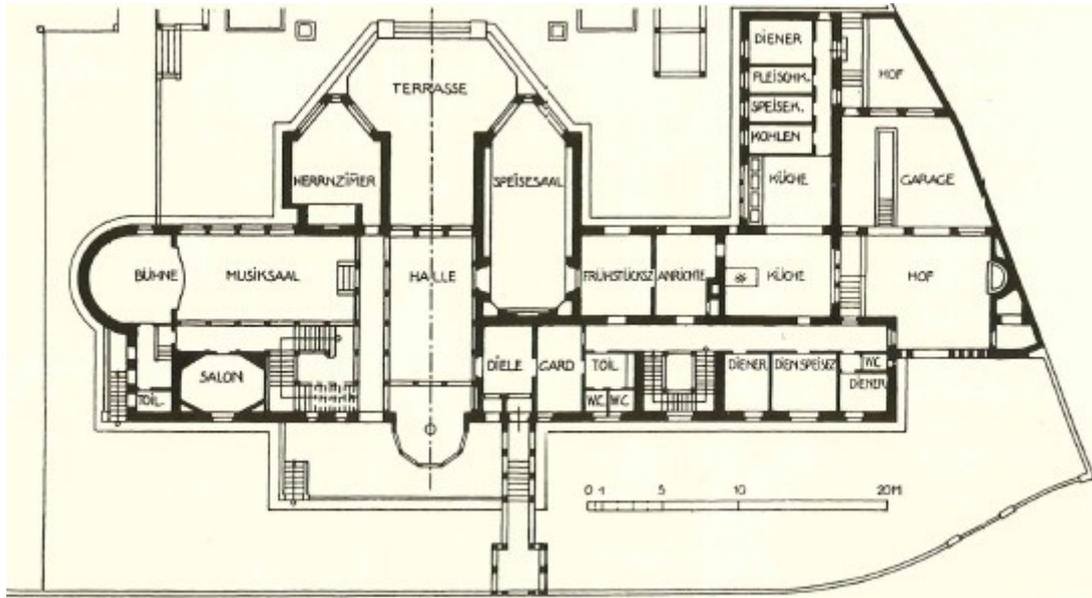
Palais Stoclet, Grundriss Erdgeschoß, Quelle: Taschen Verlag<sup>107</sup>
